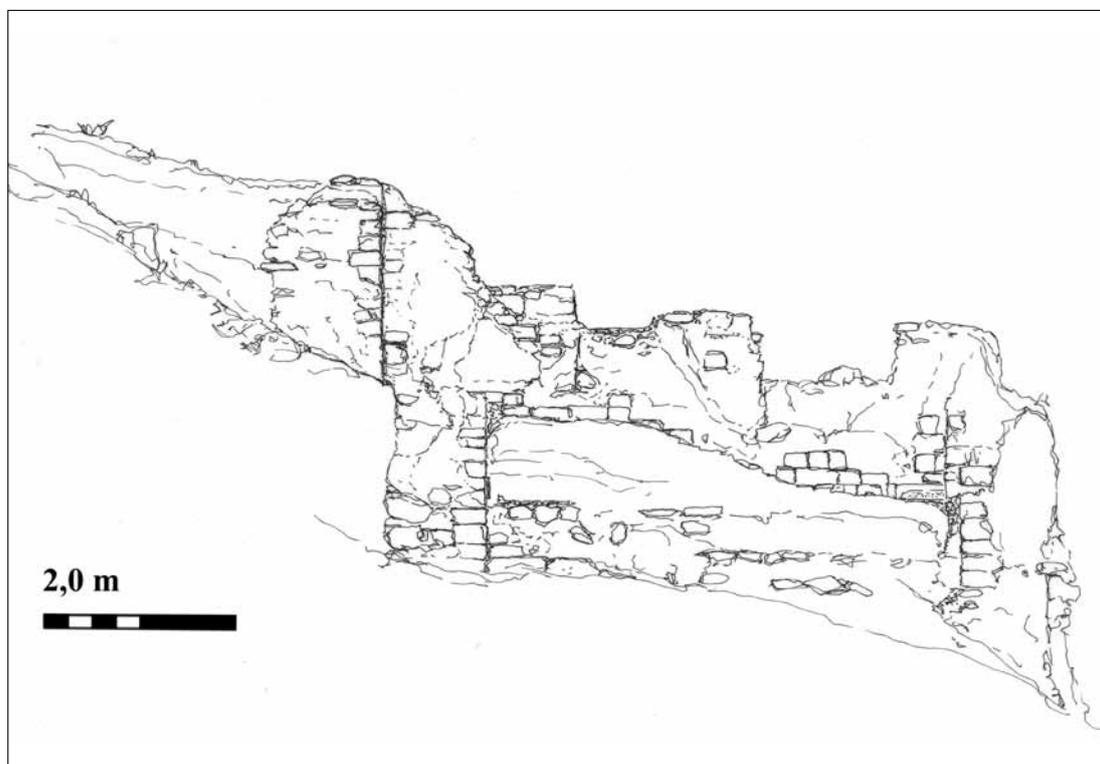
Cisterna 3.20, prospetto sud (disegno C. Frigerio).
